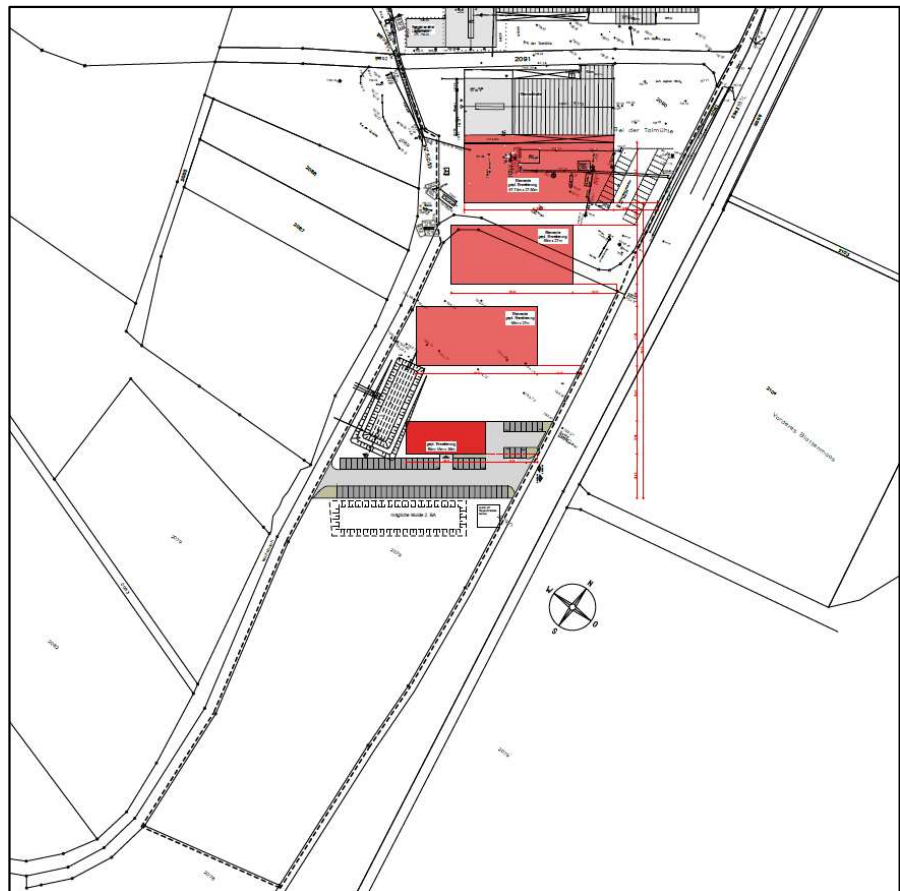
Geplante Erweiterung Fa. Brüninghoff, Planstand 22.01.2018.
